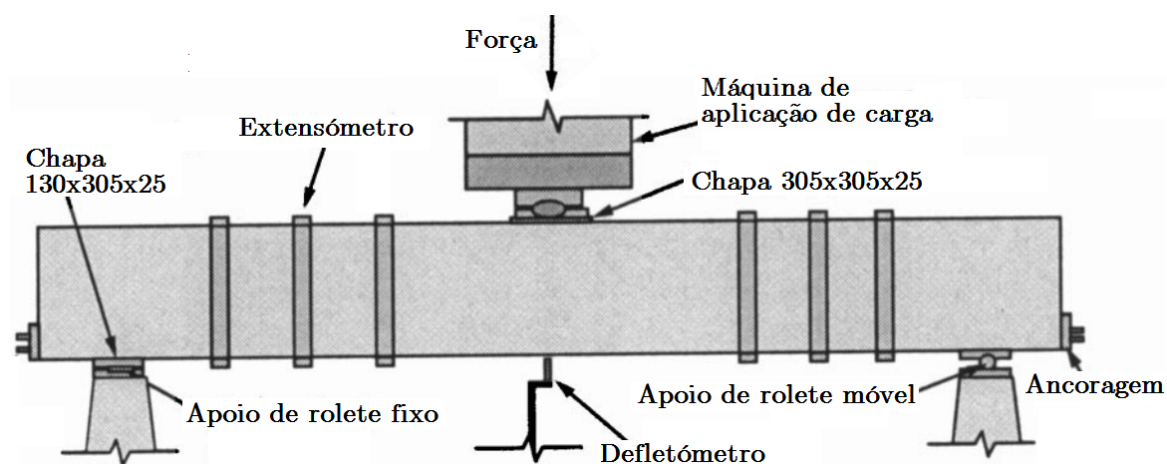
Esquema das vigas ensaiadas por Bresler e Scordelis (1963)
